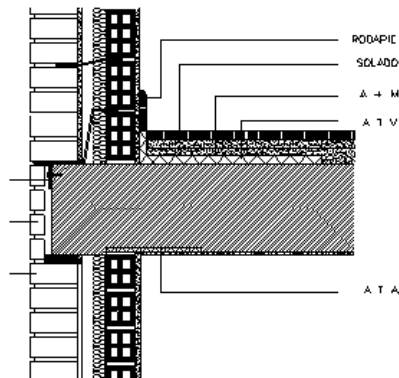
Encuentro del forjado con fachada .2006. CTE.
